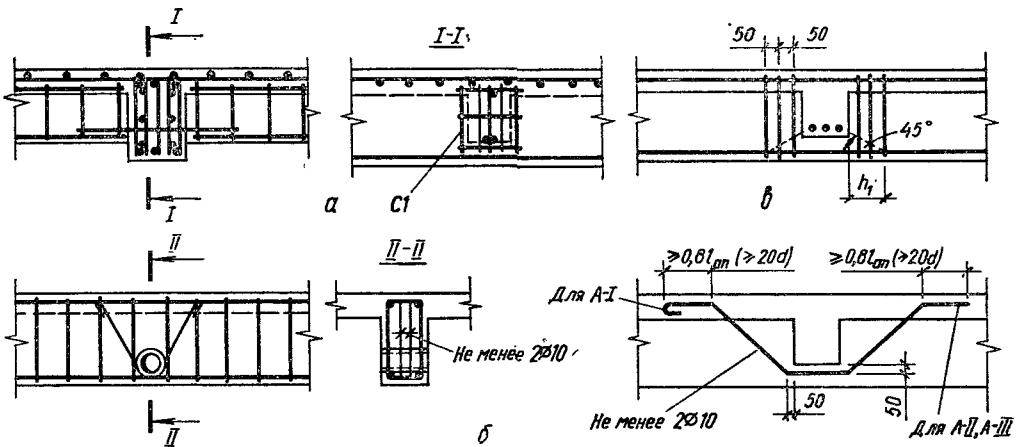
Дополнительное армирование балок в местах приложения сосредоточенных нагрузок: а — сварными сетками; б — подвесками; в — утащением хомутов. на участке h_1 (количество по расчету).
